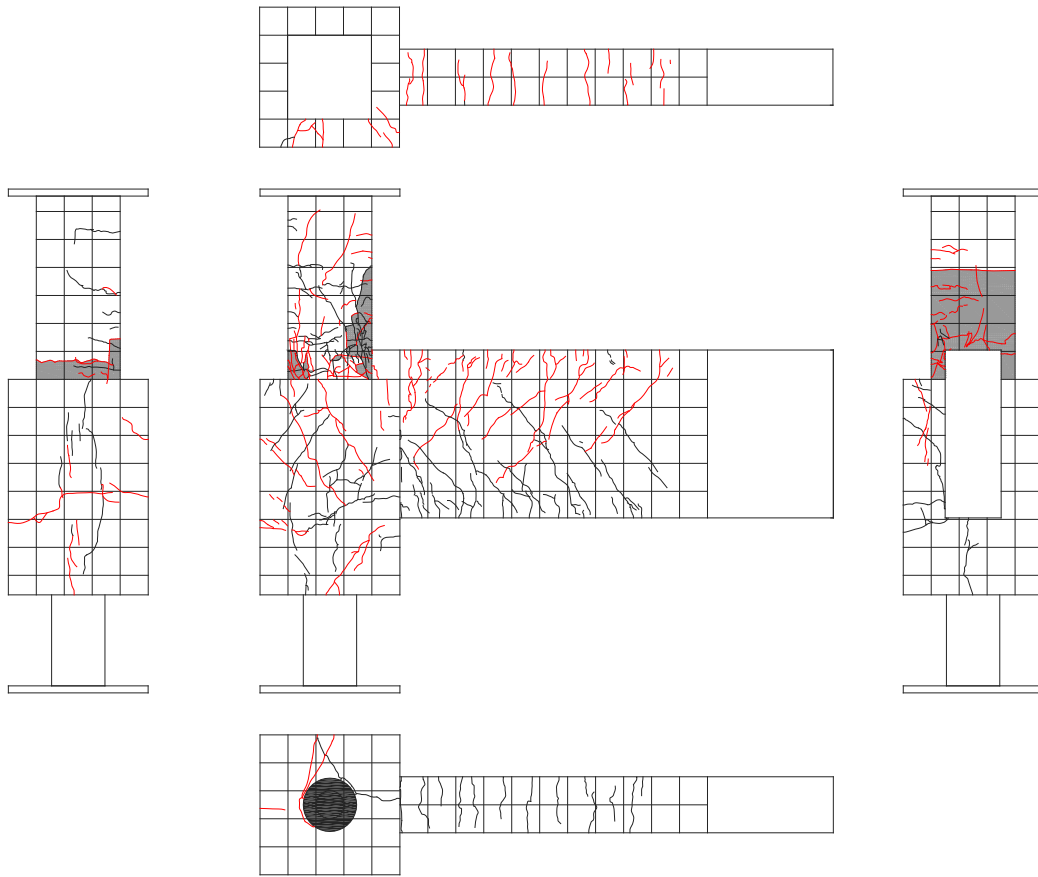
試験体 A-6 ひび割れ状況 (9Cycle)
